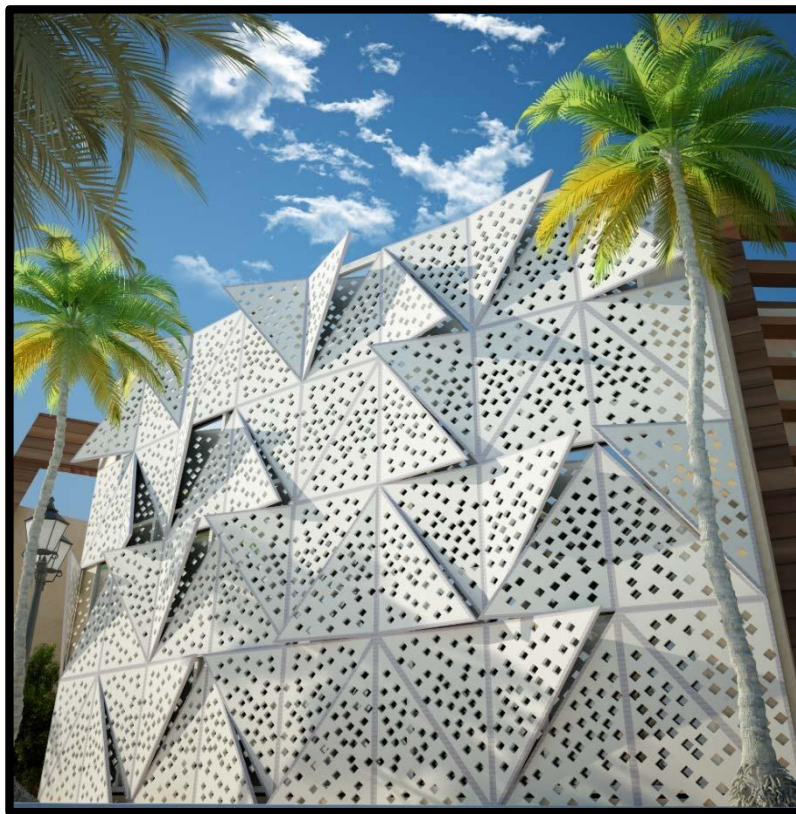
Vue sur la façade nord-ouest. Source : Auteurs.
